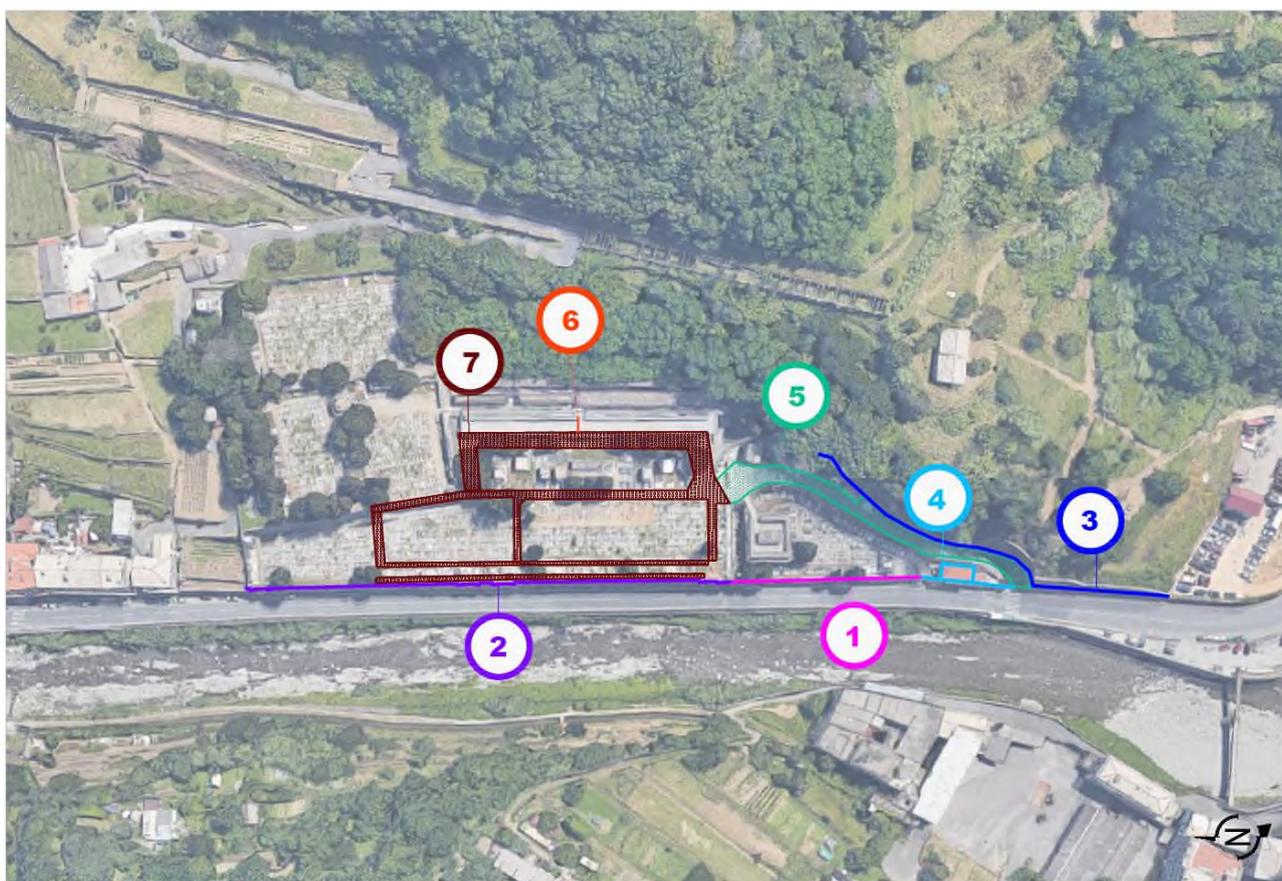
Localizzazione interventi di restauro e ripristino area cimitero.
